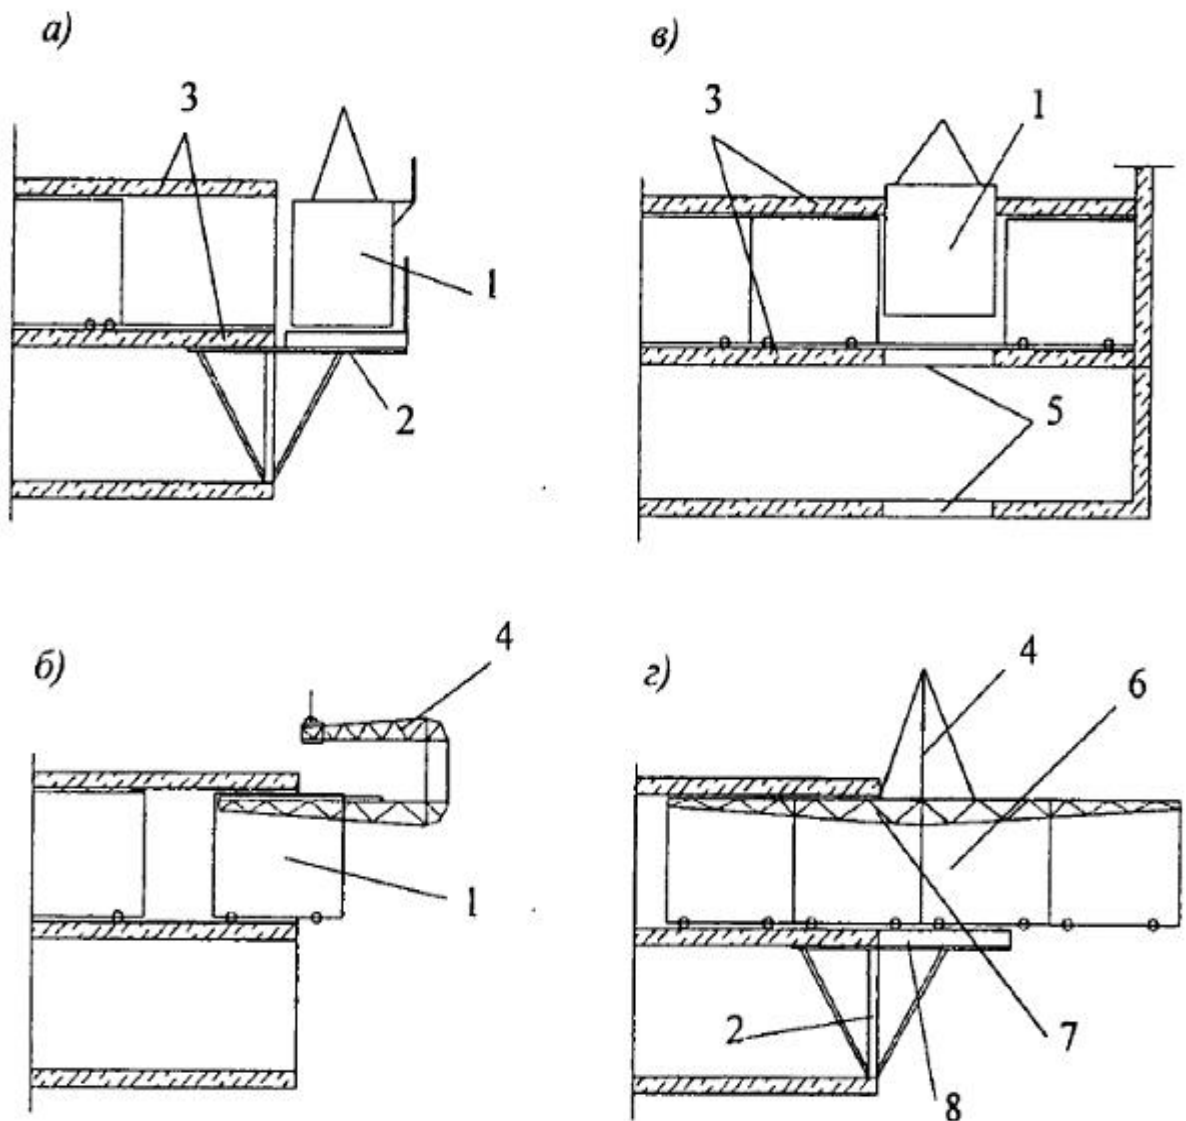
Схема демонтажу об'ємно-переставної опалубки:
